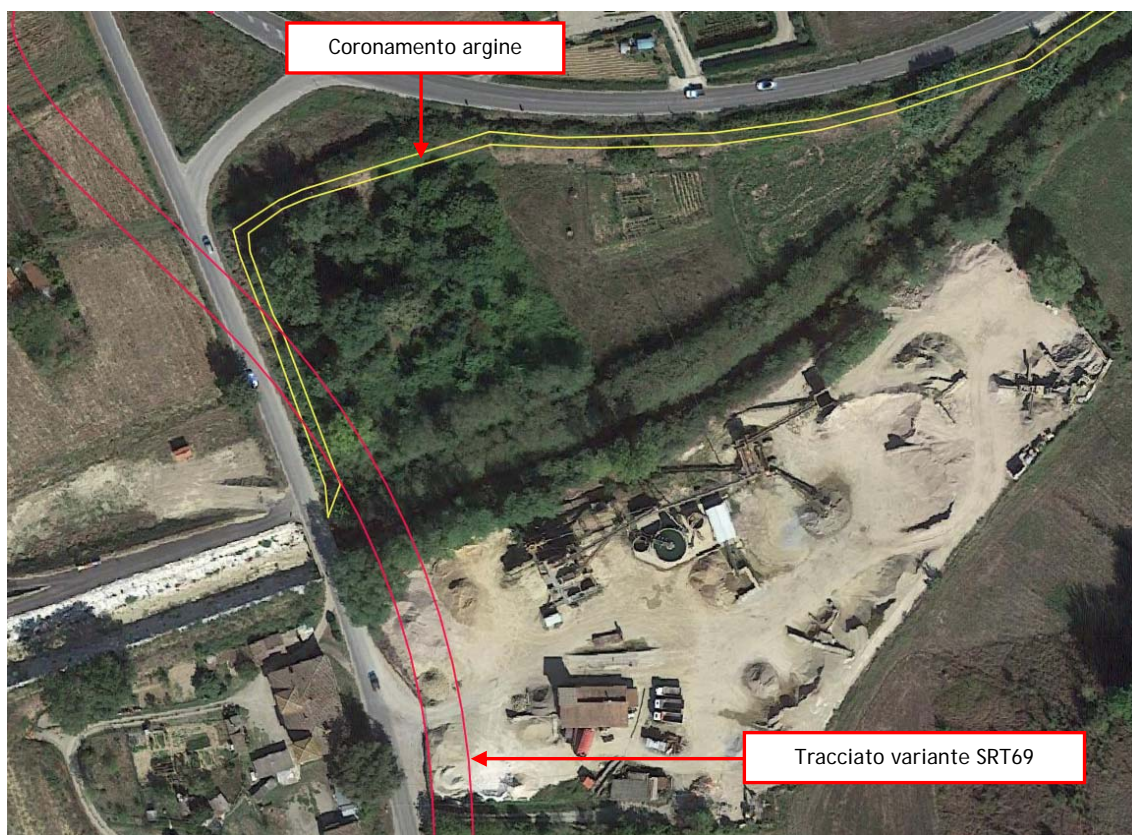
Dettaglio interferenza tracciato di progetto ed argine zona esondazione controllata.
